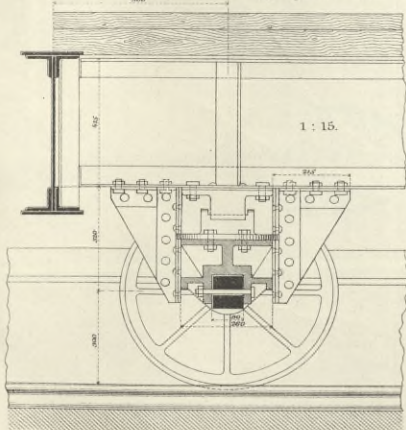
Laufräder mit Kipplager, Schnitt gh. 1:15.
